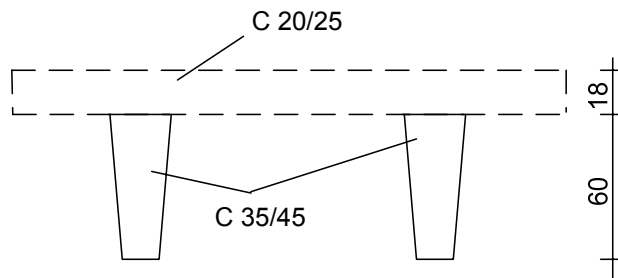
Variante 2 (Fertigteilbalken mit Ortbetonplatte)
